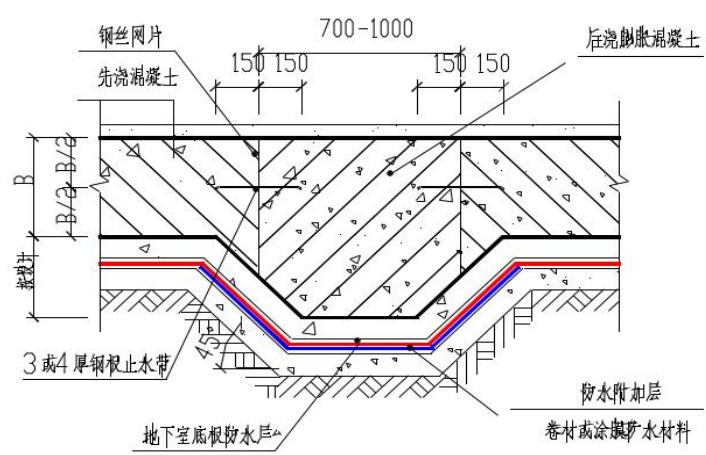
施工中利用后浇带做排水沟情况下做法
